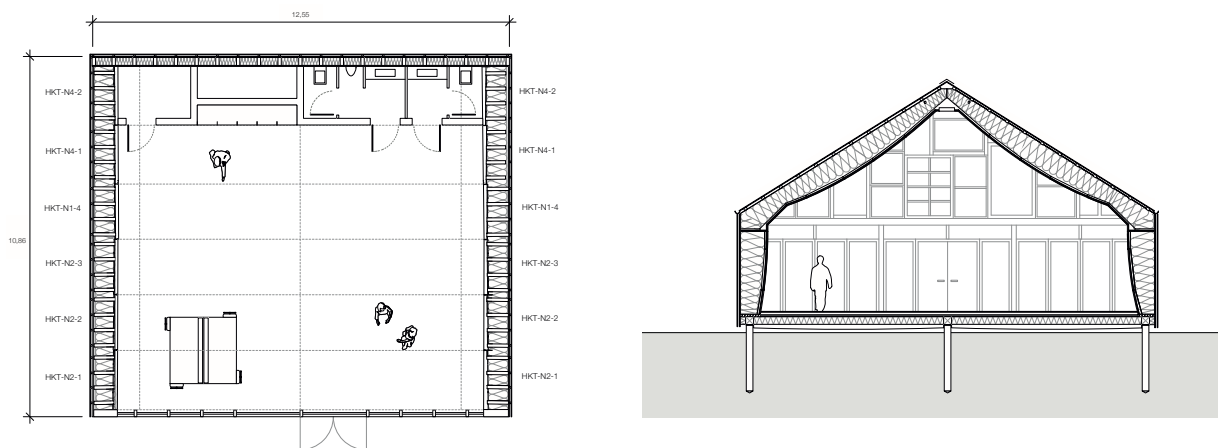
Grundriss und Schnitt Nutzungsneutrales Gebäude mit Nebenraumzone
